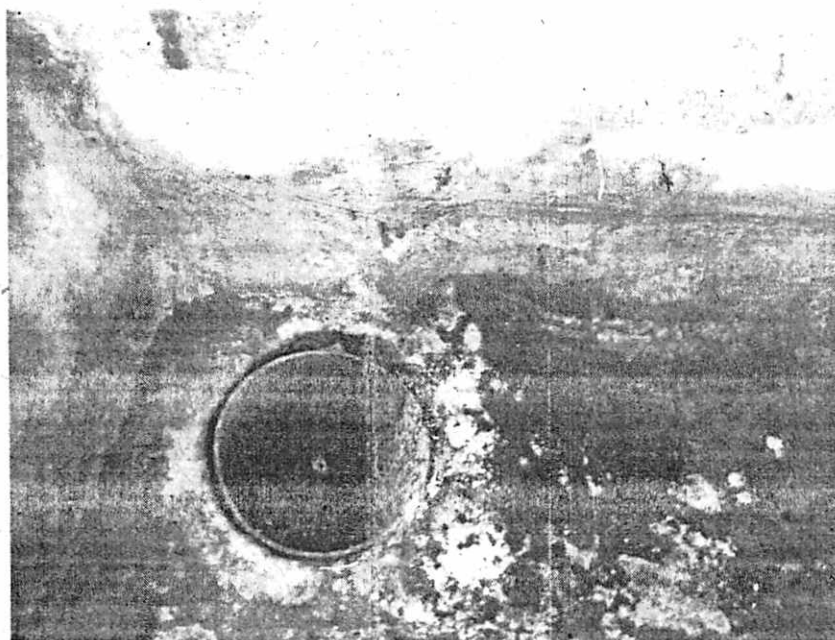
Detalhe do ralo da viga calha, tubo de descida das águas pluviais.
